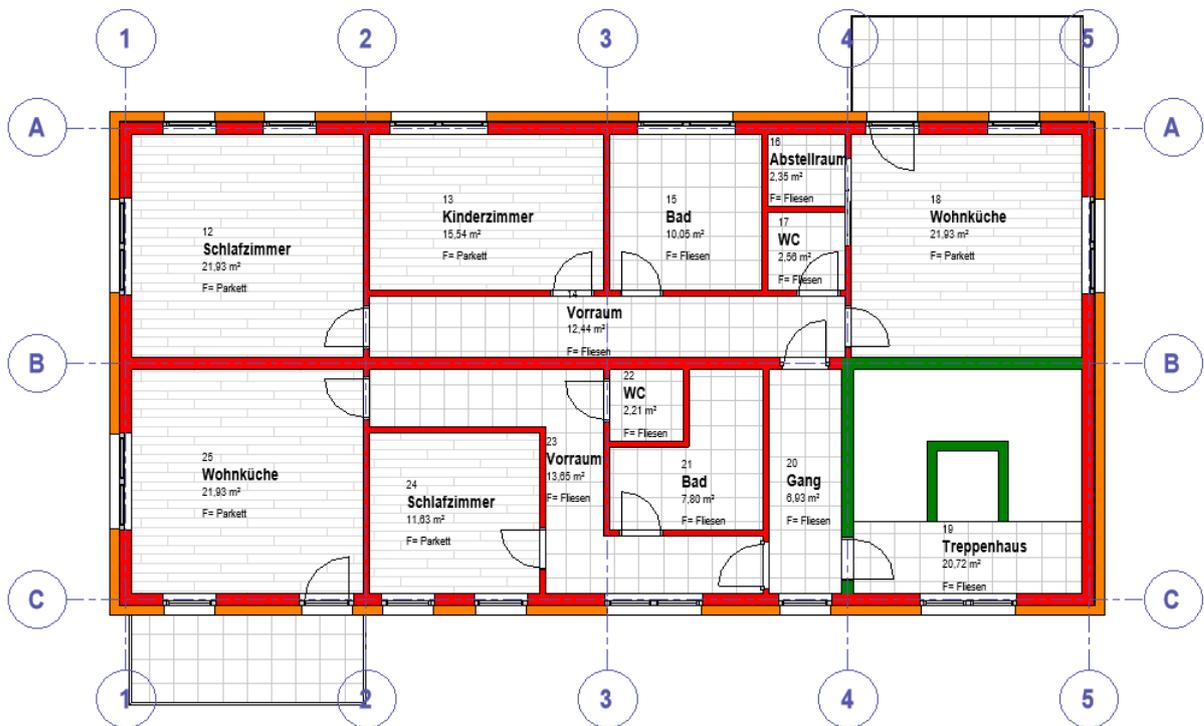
Grundriss Obergeschoss (Grün = Stahlbetonwände; Rot = Ziegelmauerwerk; Orange = Wärmedämmung)¹¹⁷
